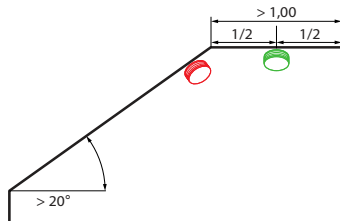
Gerade Montagefläche mindestens 1 m lang und 1 m breit
